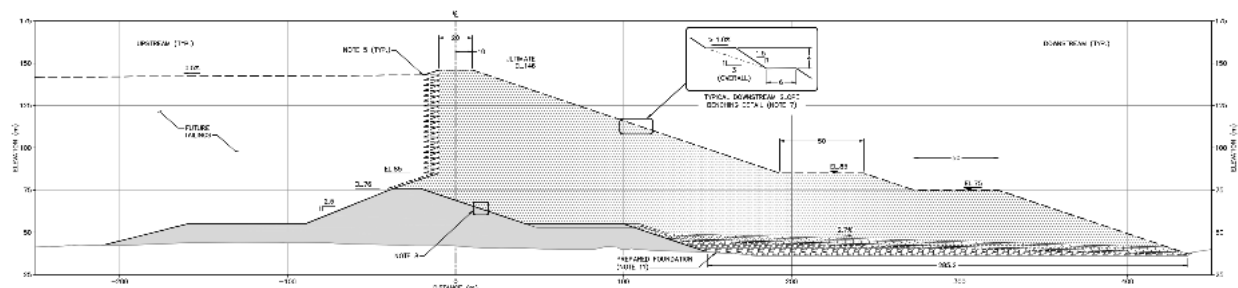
1: Sección típica de la presa norte (vista de sección desde el plano 1824-363-C02-00008)
